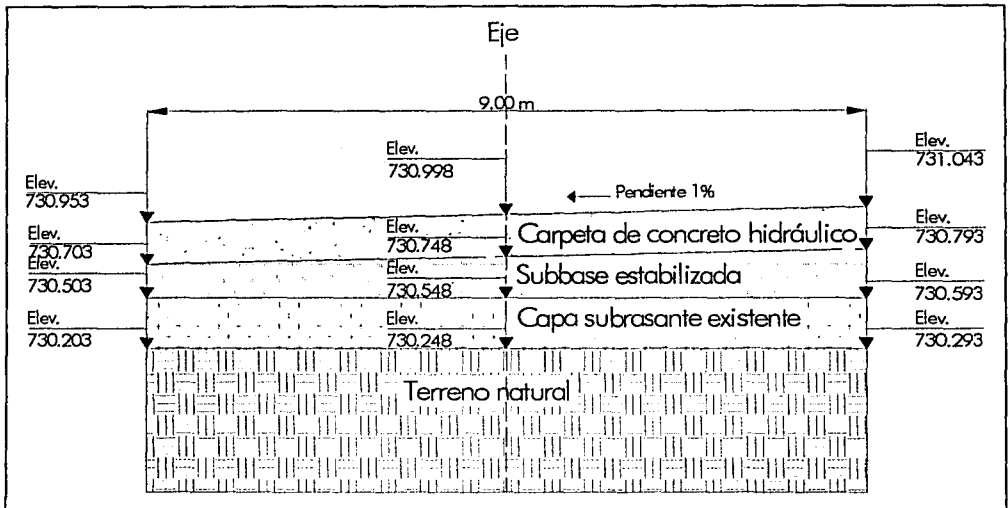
La figura muestra una sección transversal típica del pavimento de concreto con sus respectivas elevaciones de cada una de las capas.
